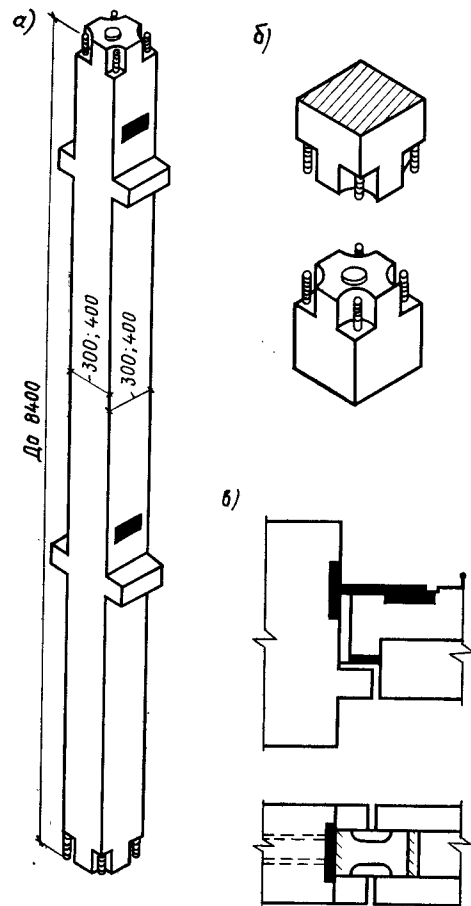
Колонна каркаса многоэтажных зданий:
